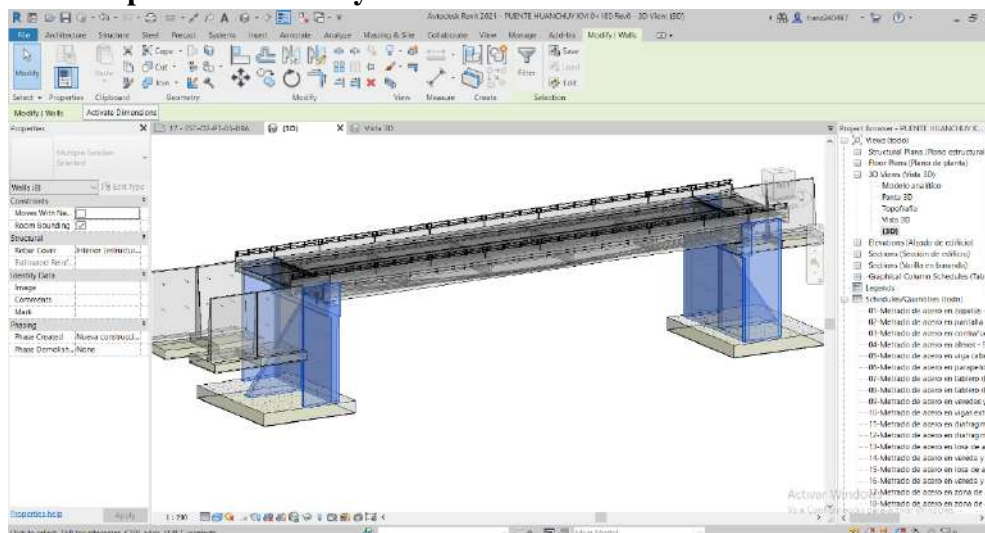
Modelado de las zapatas de los estribos del puente Huanchuy
